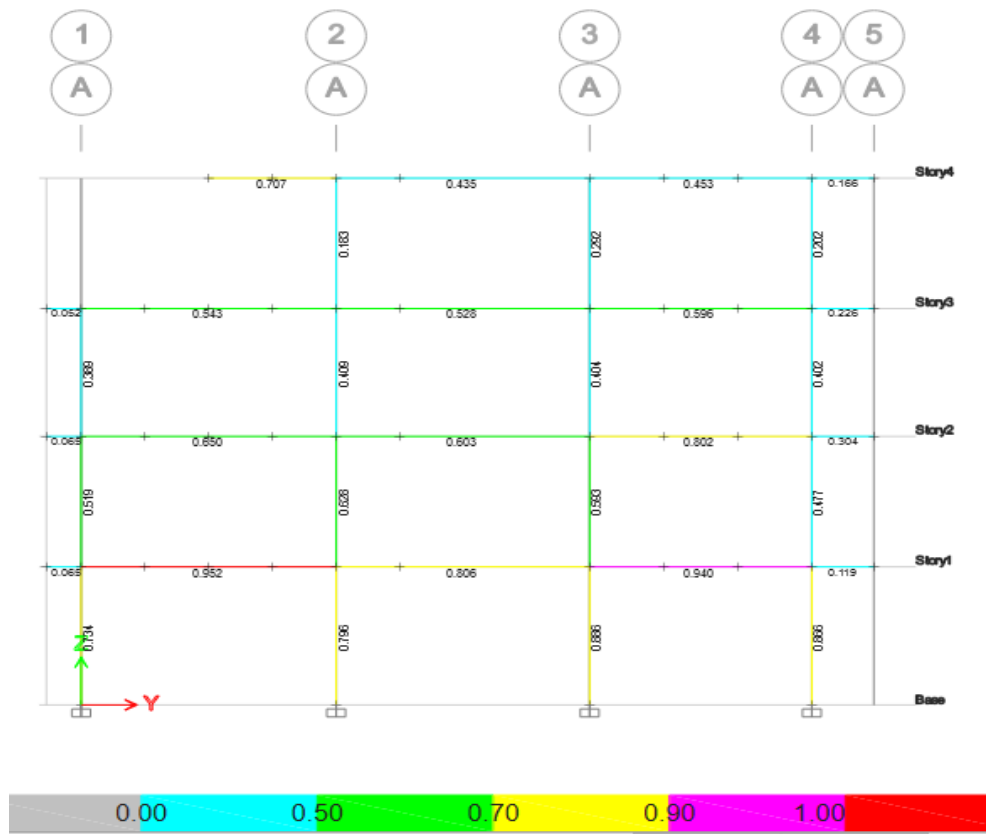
Vista en elevación eje A de secciones principales, con diseño AISC 360-16- demanda/capacidad
